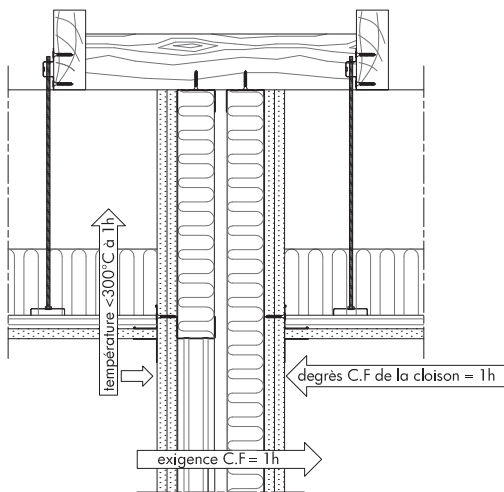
Cloisons fixées sous la structure - ERP type U
